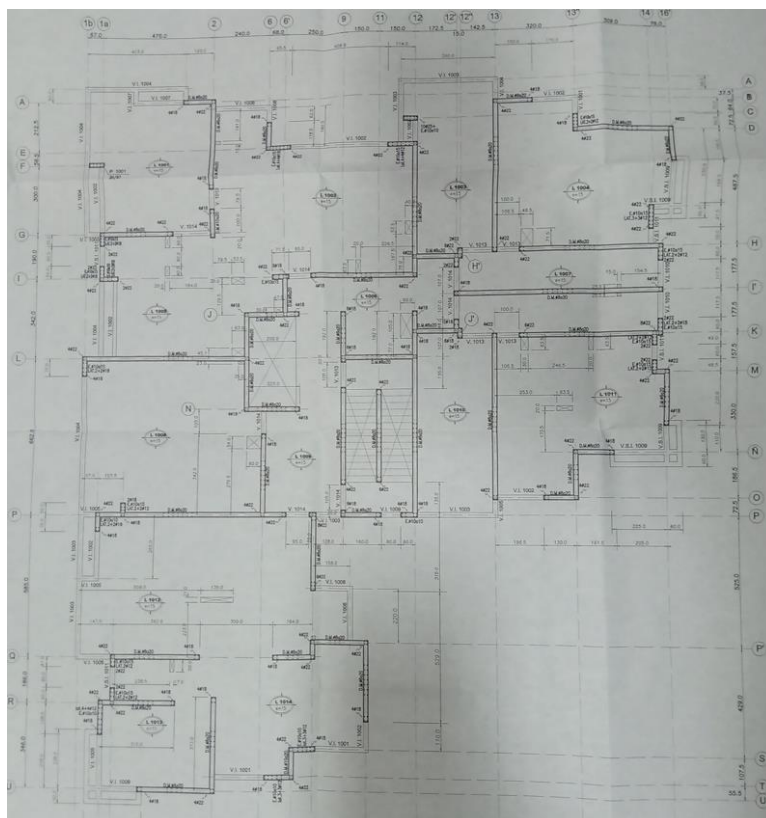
Planta típica de pisos 10-15 en edificio Toscana. Fuente: Rodrigo Navarro.
